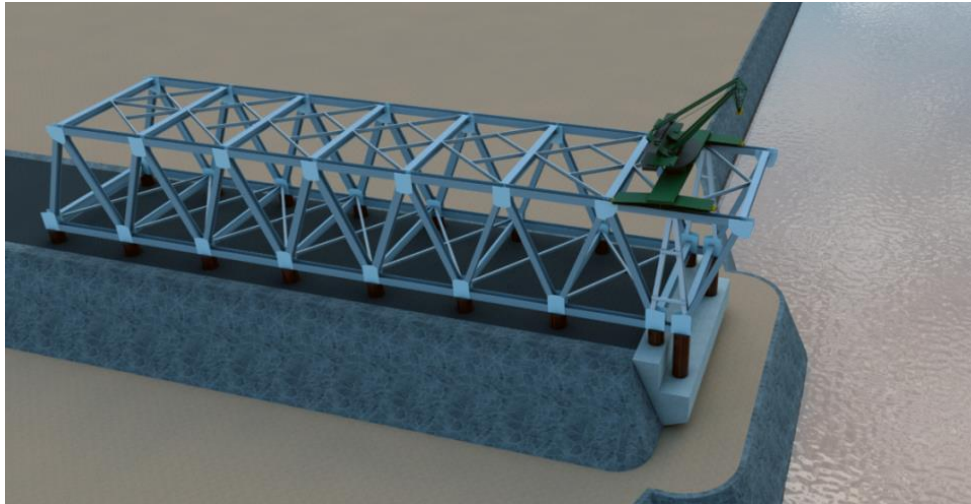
Tampak dekat jembatan rangka baja
